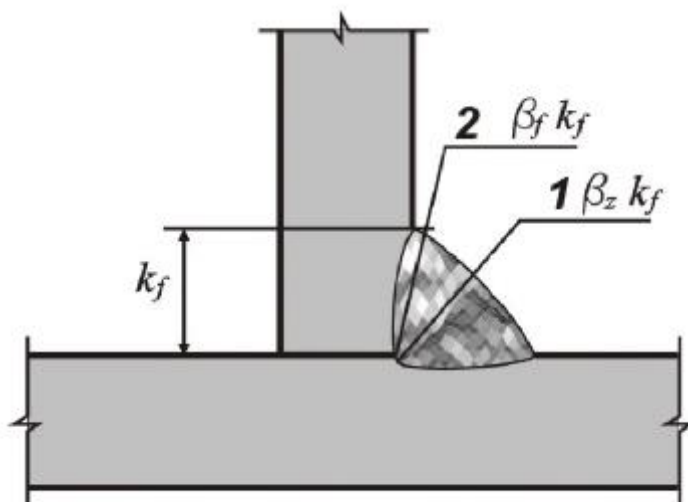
Схема расчетных сечений сварных соединений с угловыми швами.
